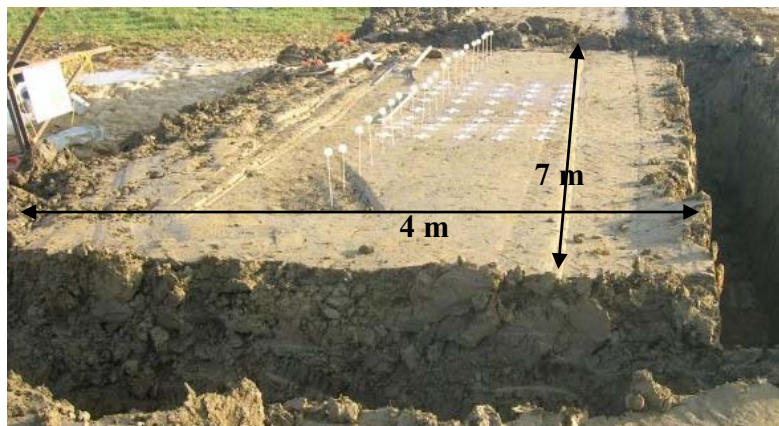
Planche d'essai sur site [Camp, 2008]
